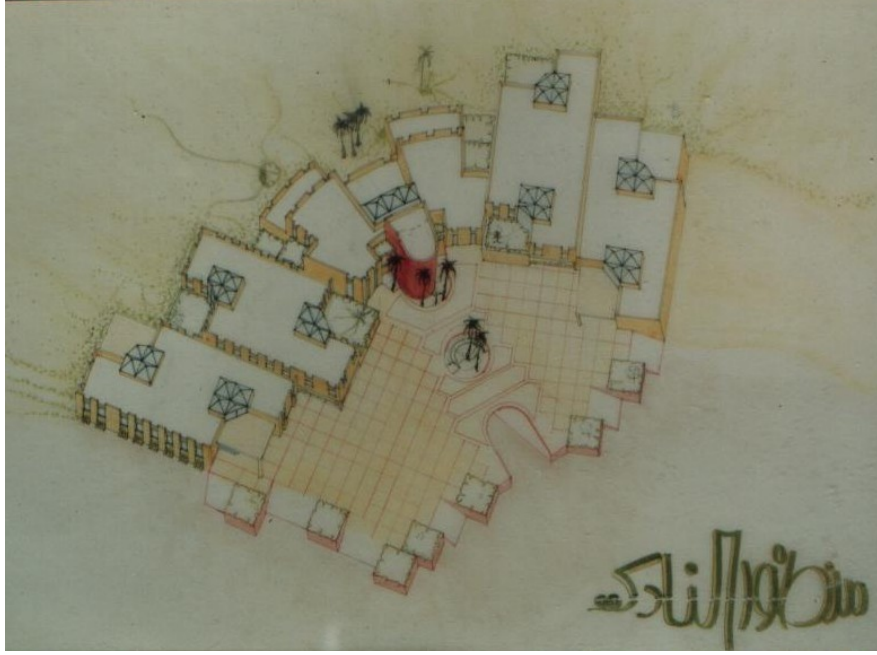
مسقط الدور الأول لمشروع نادي اجتماعي:
